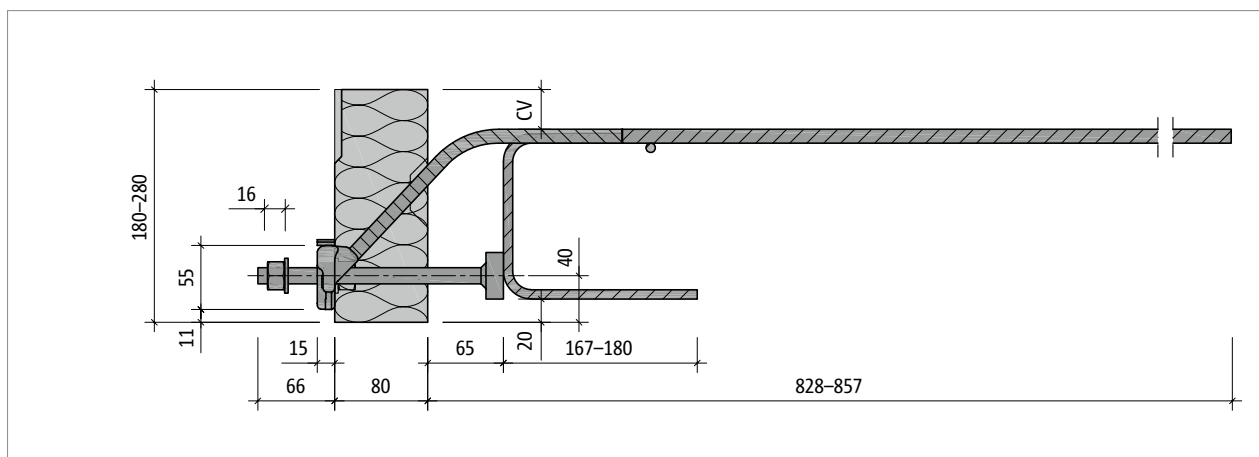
Schöck Isokorb® T type SQ-V3 : coupe du produit
